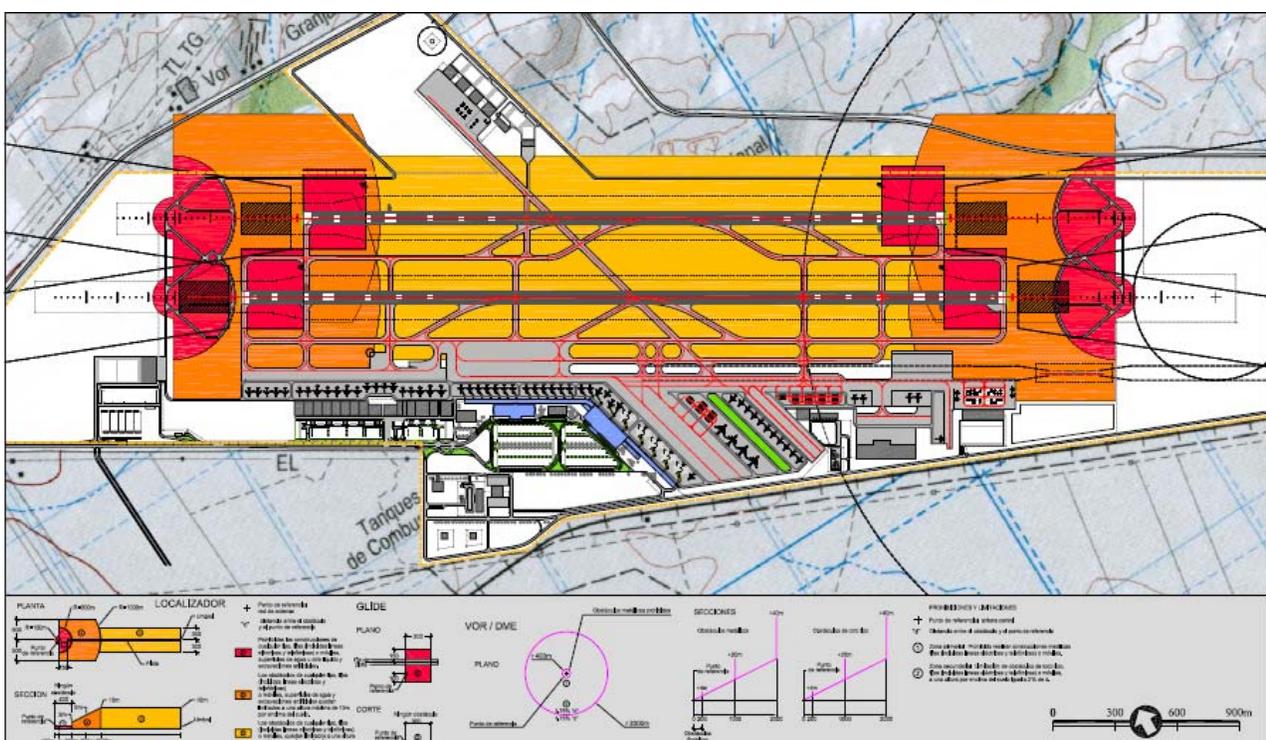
Pistas proyectadas en el Plan Maestro actual.
